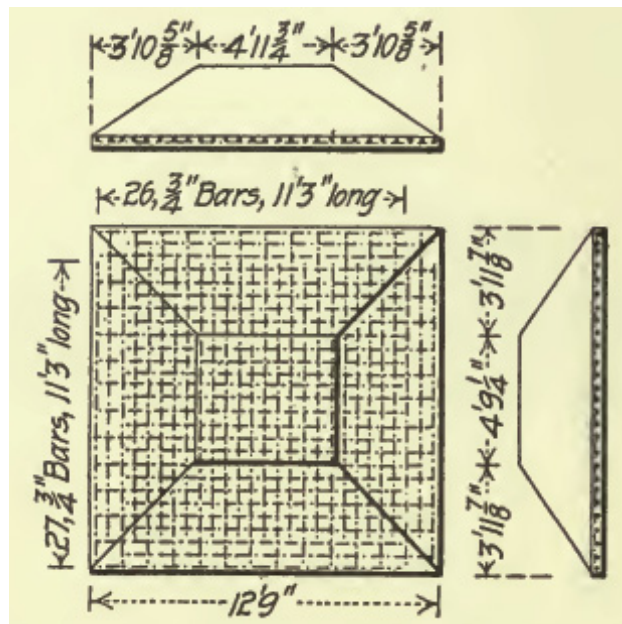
Zapata aislada de hormigón armado. Buel [3].
